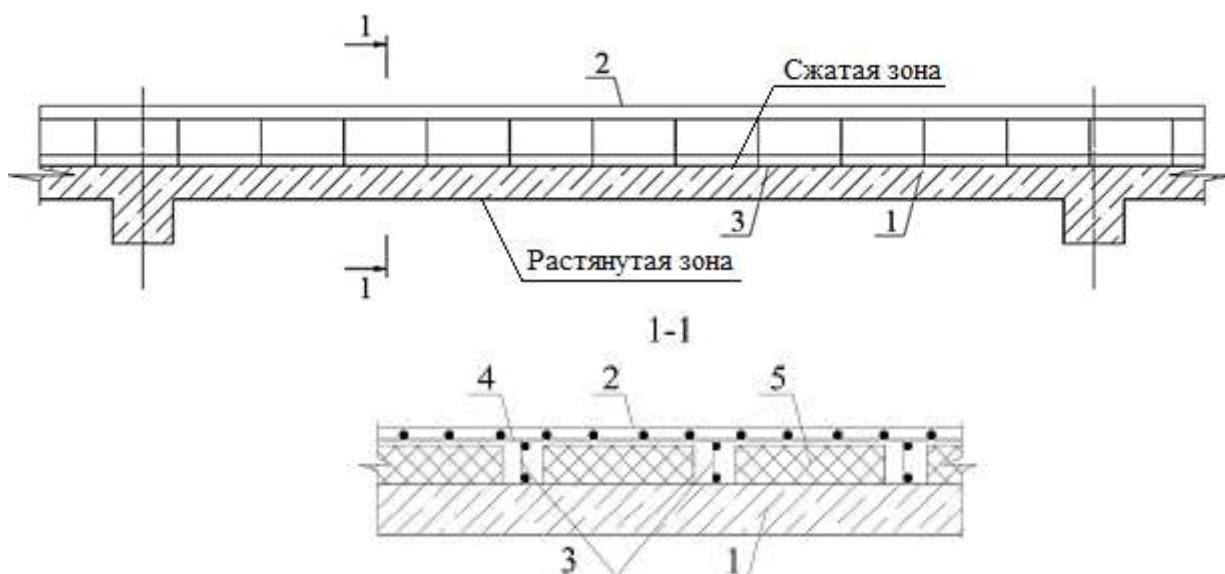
Устройство дополнительной монолитной плиты из фибробетона сверху: 1 – усиливаемая плита; 2 – монолитная ребристая плита из фибробетона; 3 – арматурные каркасы наращивания; 4 – арматурные сетки наращивания; 5 – пустотообразователь (пенопласт, пенополистерол и др.).
